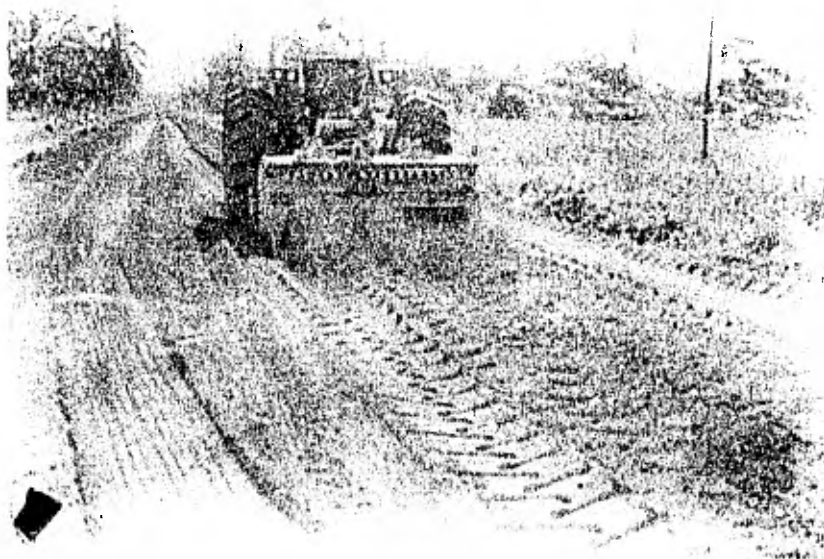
Secado de arena para estabilizarla con cemento portland.
